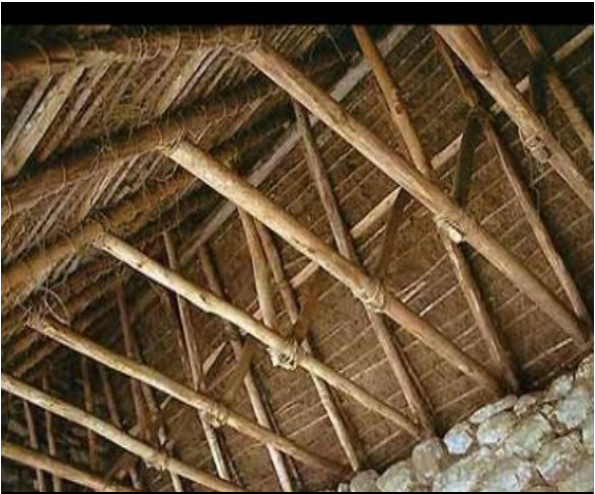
ESTRUCTURA DE MADERA CON CUBIERTA DE PALMA
